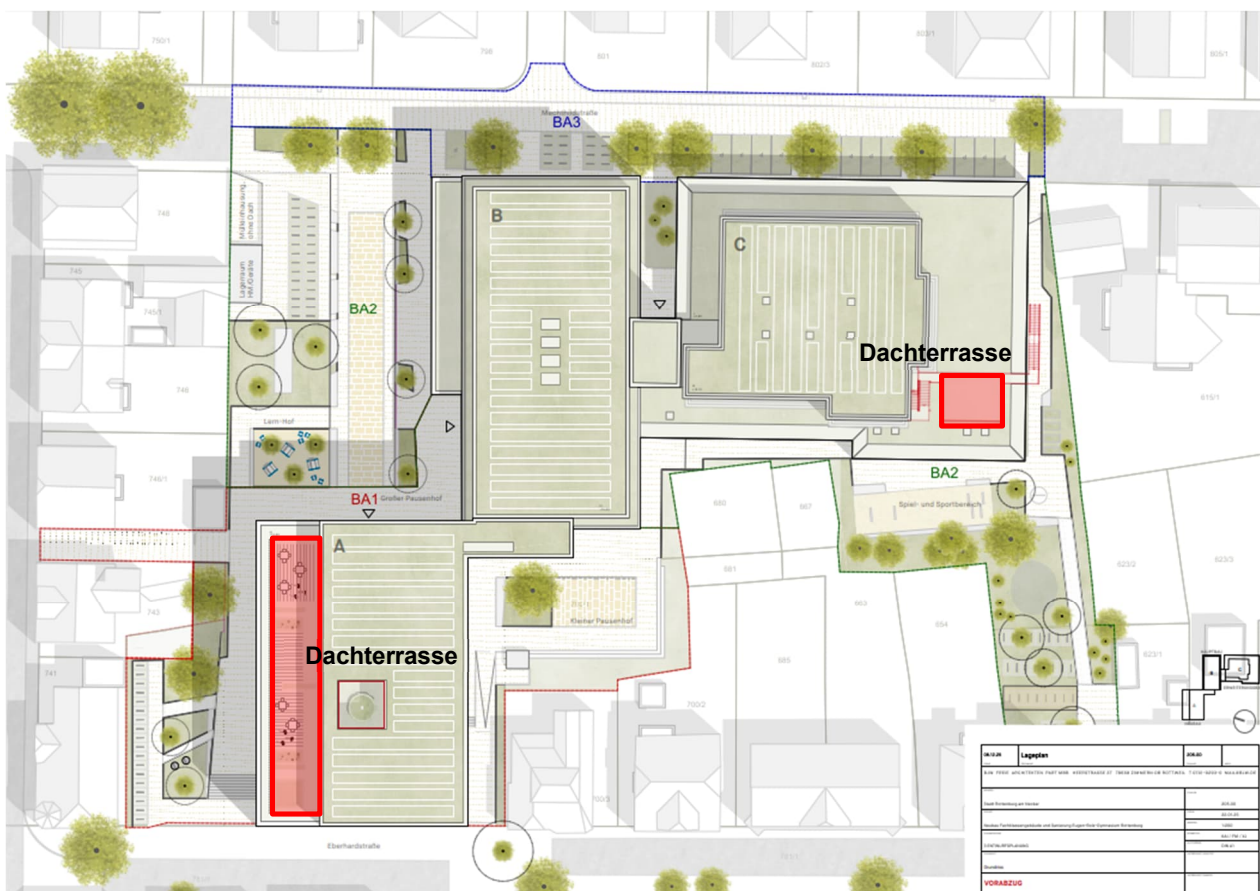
Lageplan mit Kennzeichnung der Dachterrassen
